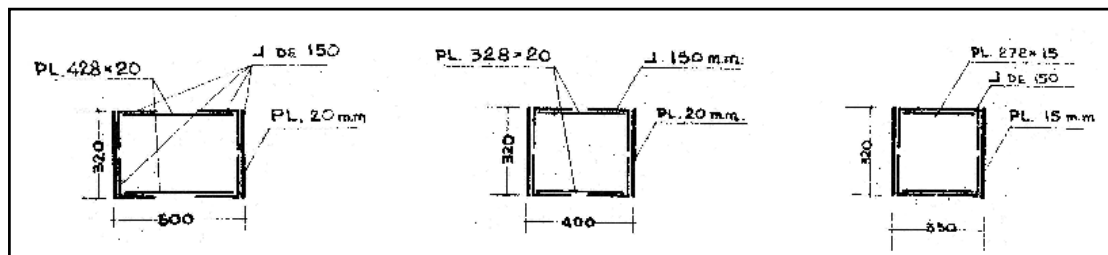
Seccions de les columnes metàl·liques de les torres. Font: Memòria de càlculs
